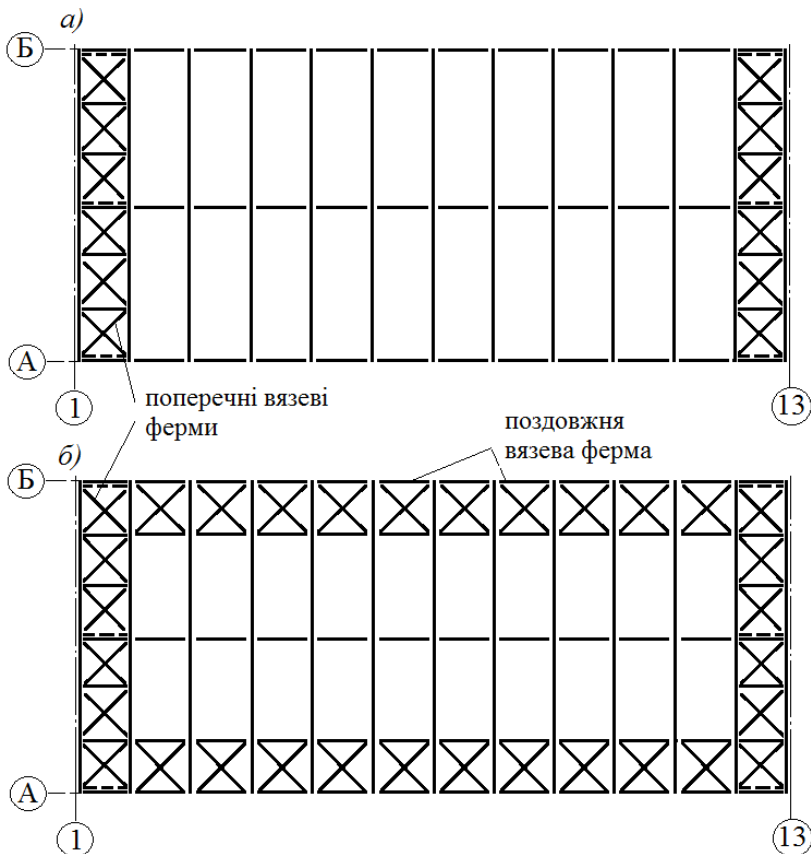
Схеми горизонтальних в'язей між сталевими фермами уздовж: а) - верхнього поясу; б) - нижнього поясу
